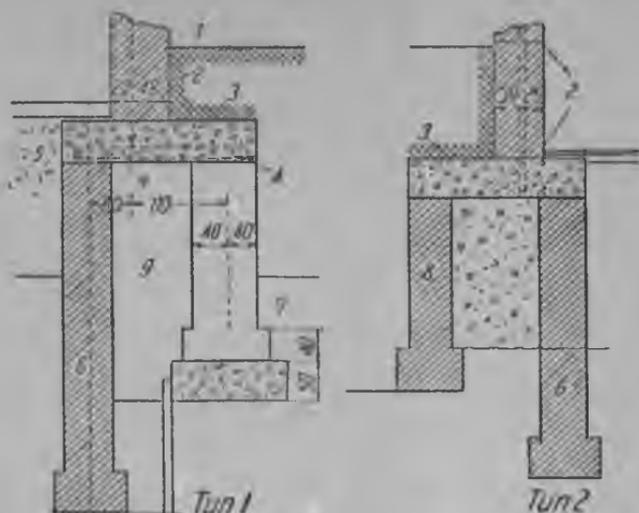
Типы фундаментов: 1 — тропуар, 2 — гидроизоляция, 3 — бетон, $R=110 \text{ кг/см}^2$, 4 — рельс через 40 см, 5 — шлак, 6 — существующая кирпичная стена, 7 — бутовая стена, 8 — бетон, $R=65 \text{ кг/см}^2$, 9 — засыпка строительным мусором.
